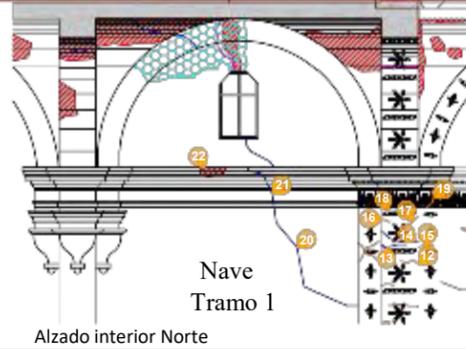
Detalle de afectaciones existentes en muro interior norte
